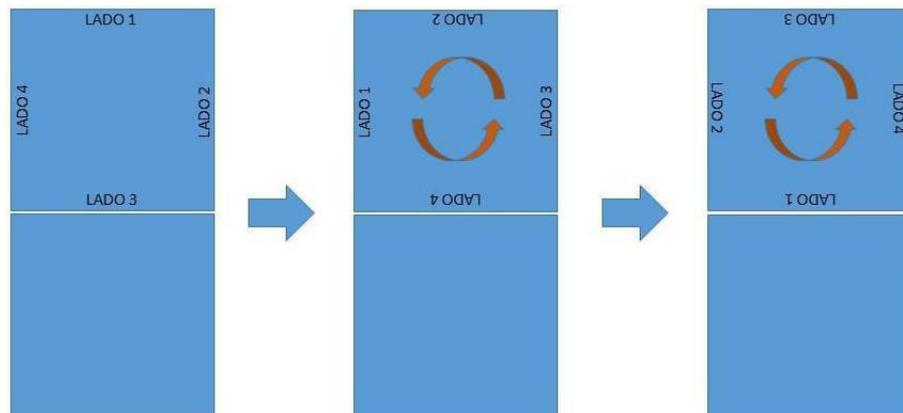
Desenho esquemático da técnica de giro do piso.
